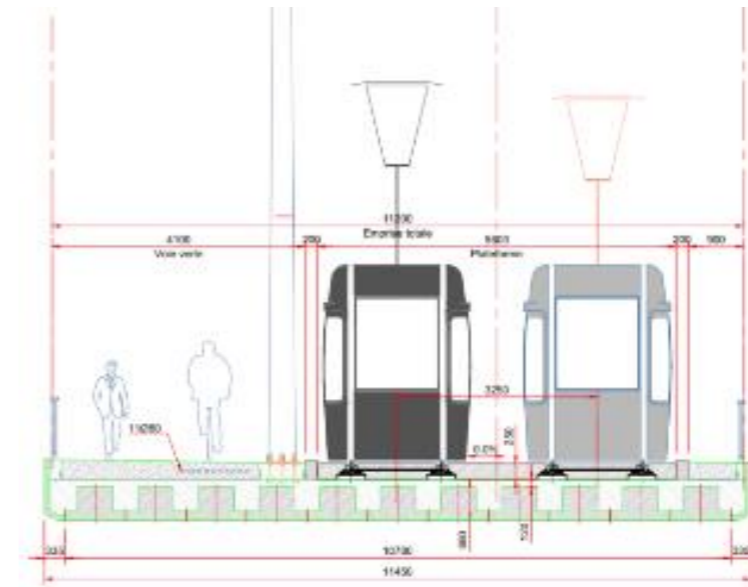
coupe fonctionnelle prévue au droit de l'OA8
